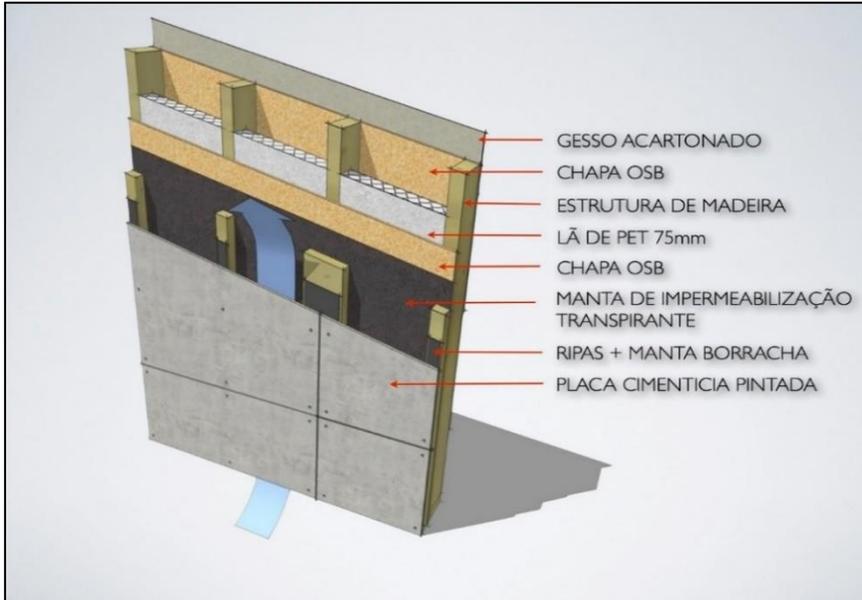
Detalhe de Parede Estrutural em *Wood Frame
